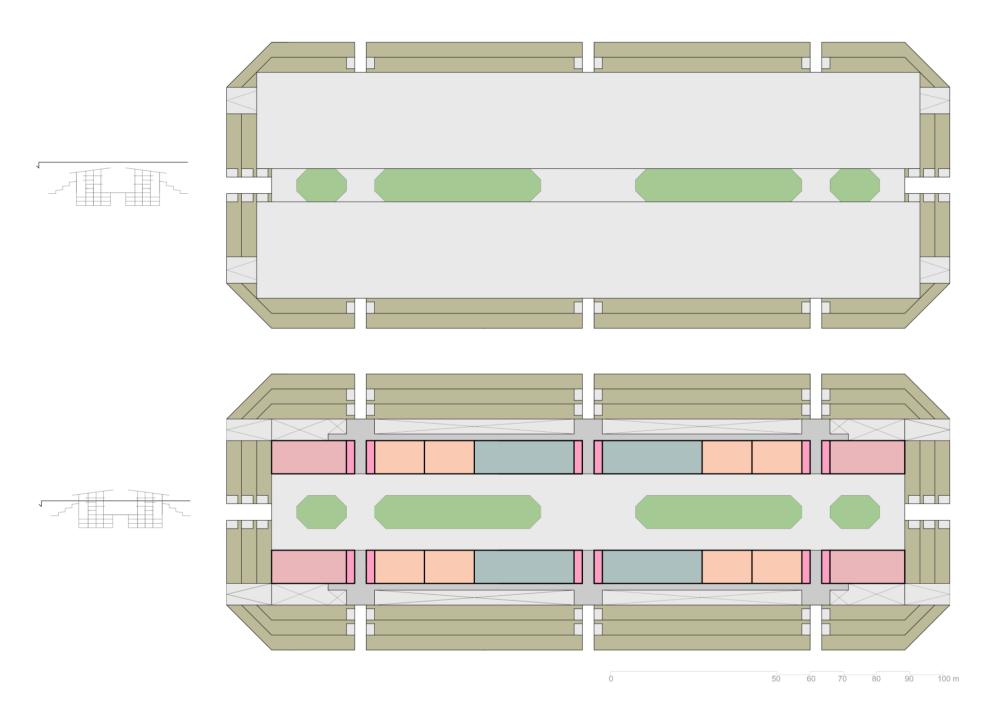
planta de cubiertas (arriba) y planta desde la tercera planta (abajo)
